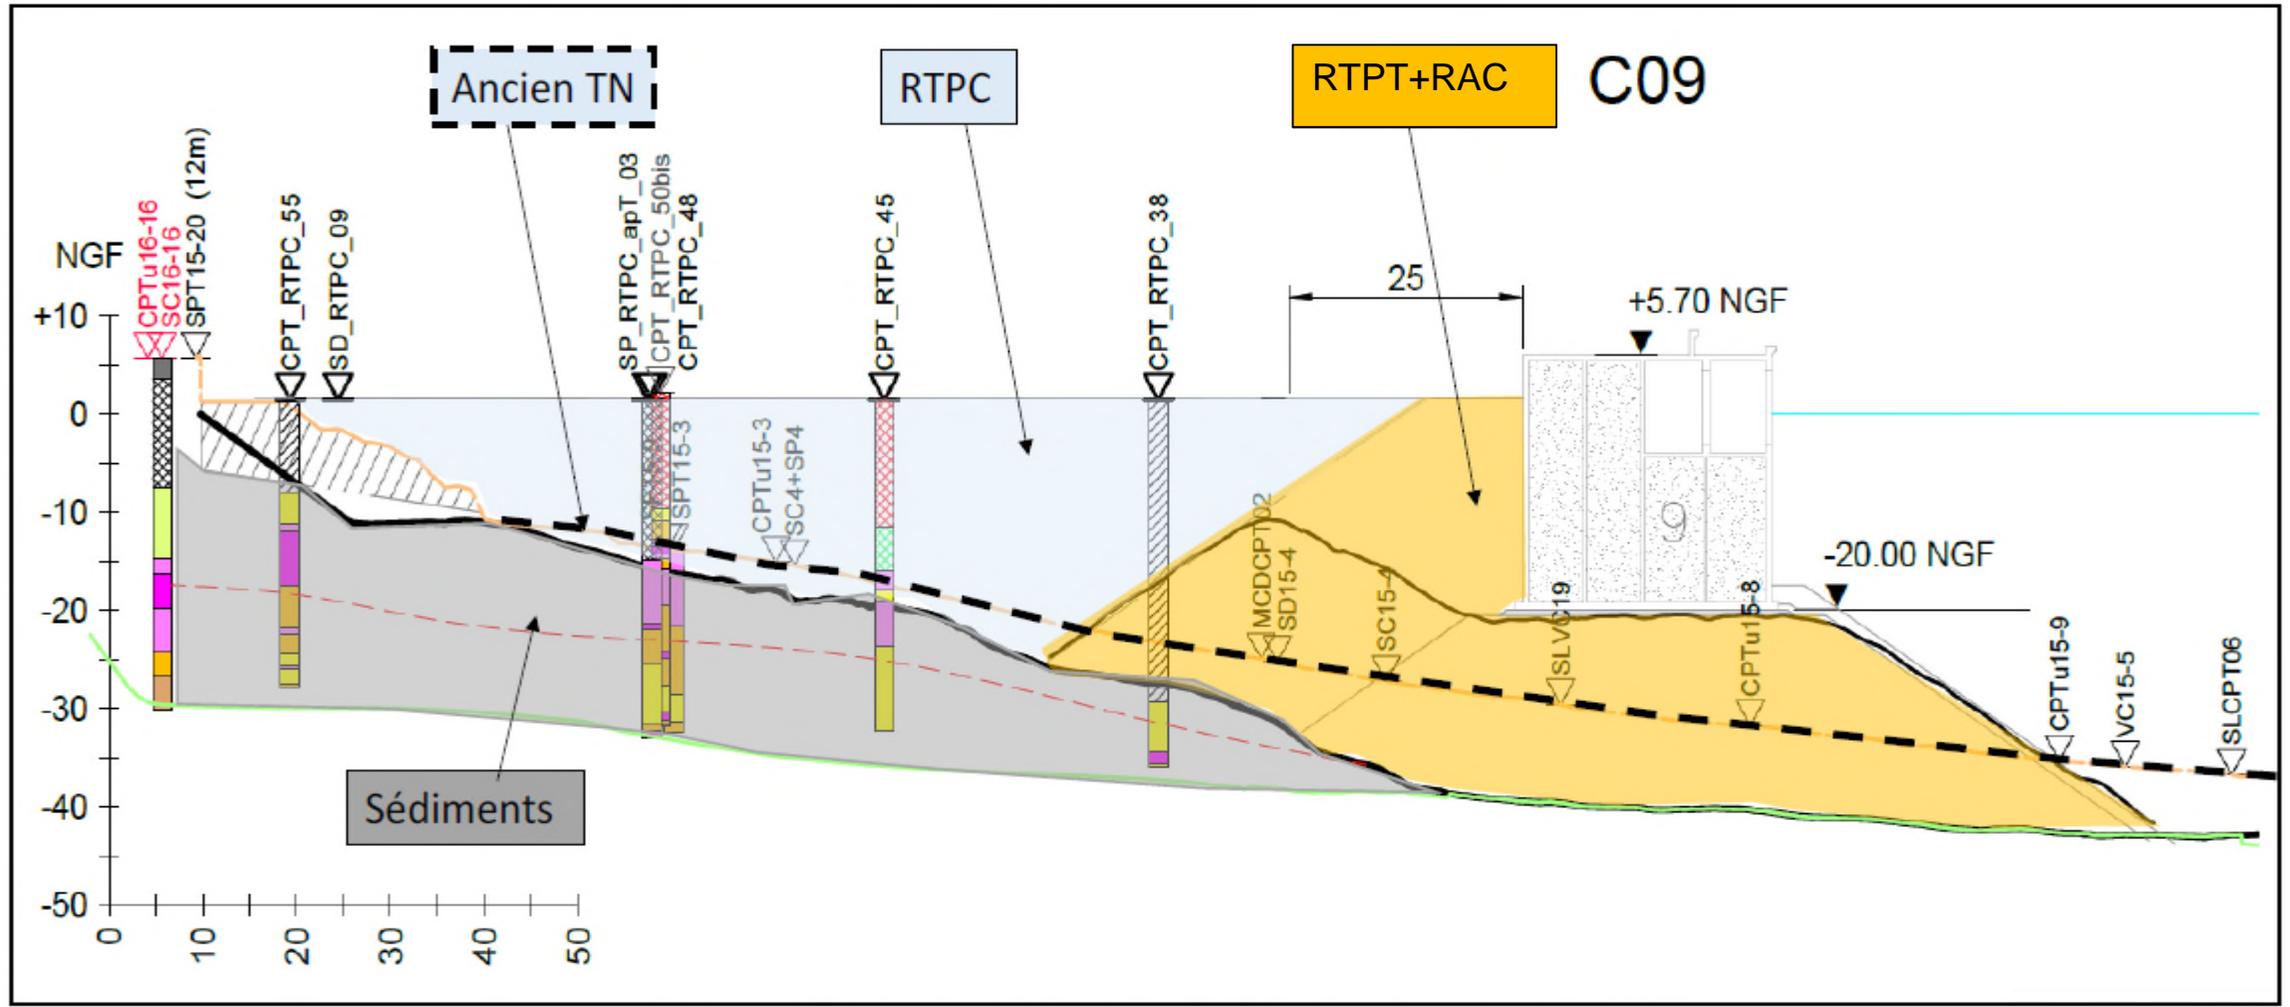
Coupe géotechnique synthétique au droit d'un caisson
